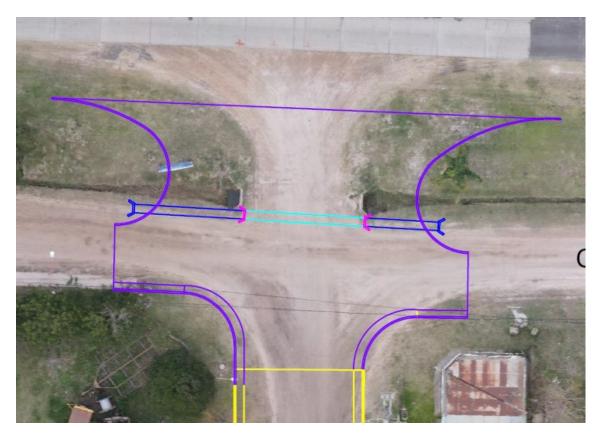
Implantación propuesta de conexión calle Besada – COLECTORA – INGRESO
